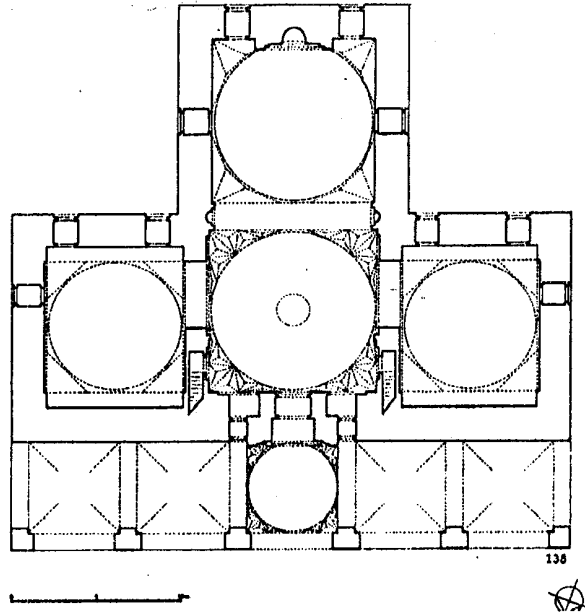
مسقط أفقي لجامع بايزيد يلدريم في بورصة (أوبروسه) (عن : Wilde)
